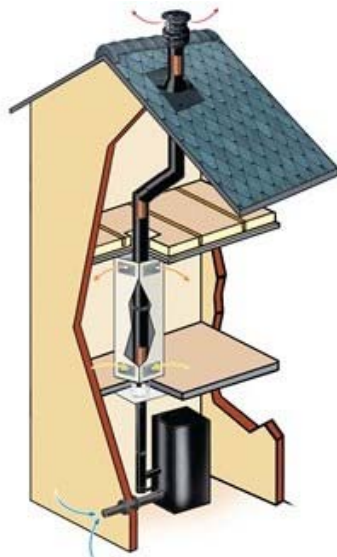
Départ plafond (tubage flexible d'un conduit métallique existant avec raccordement simple paroi)
